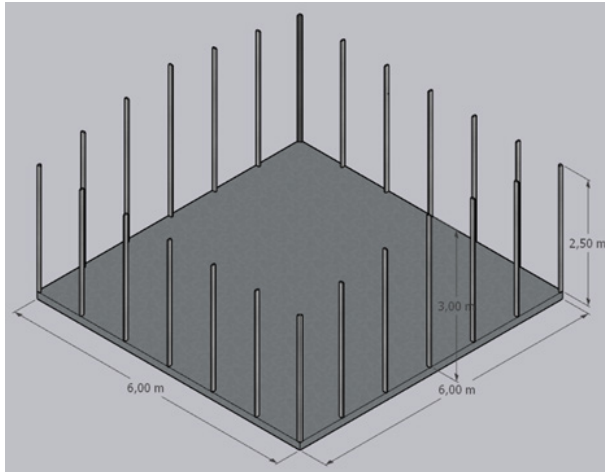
Colocación de los perfiles de aluminio galvanizado.
